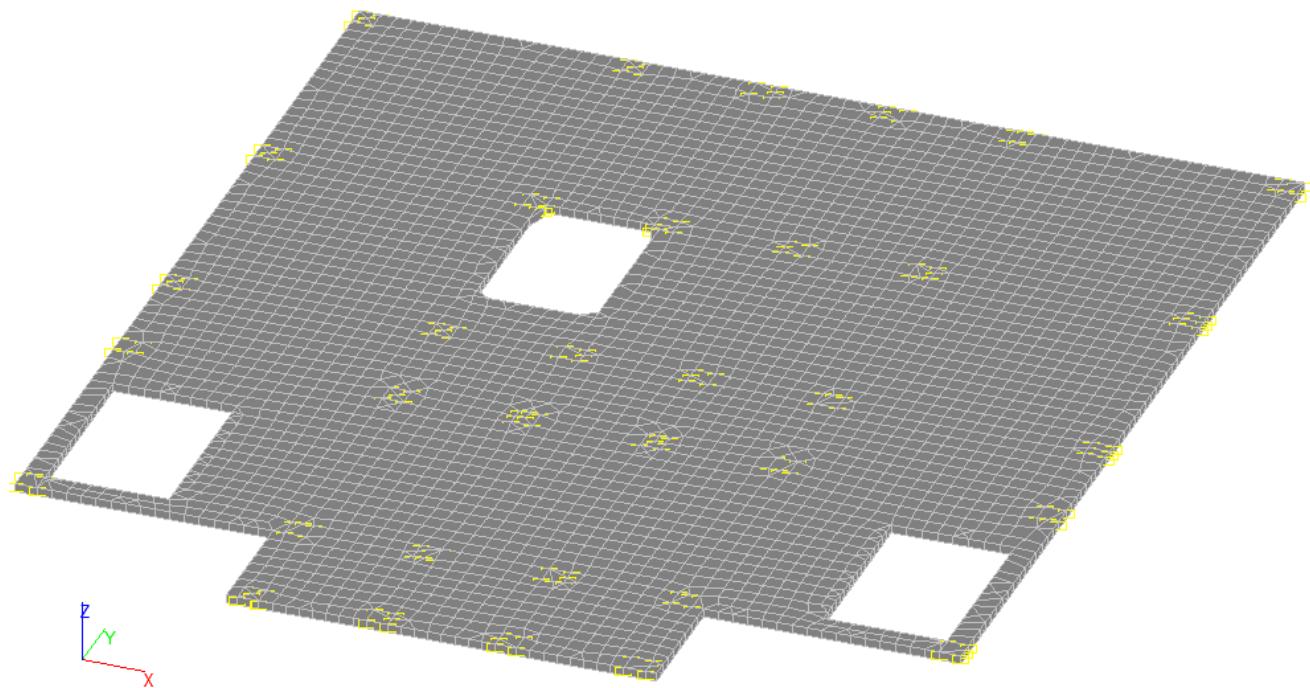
Расчётная схема плиты перекрытия в пространстве
